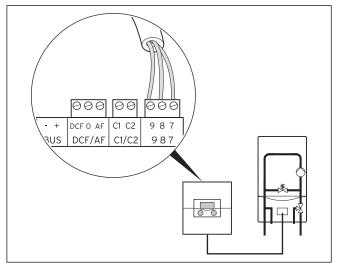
Collegamento dell'apparecchio di riscaldamento
